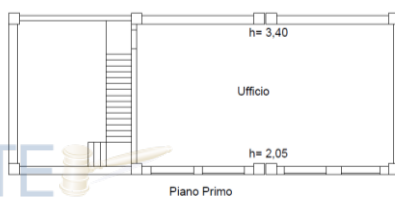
Planimetria rilevata del primo piano dell'opificio con indicazione della destinazione d'uso (non in scala)
